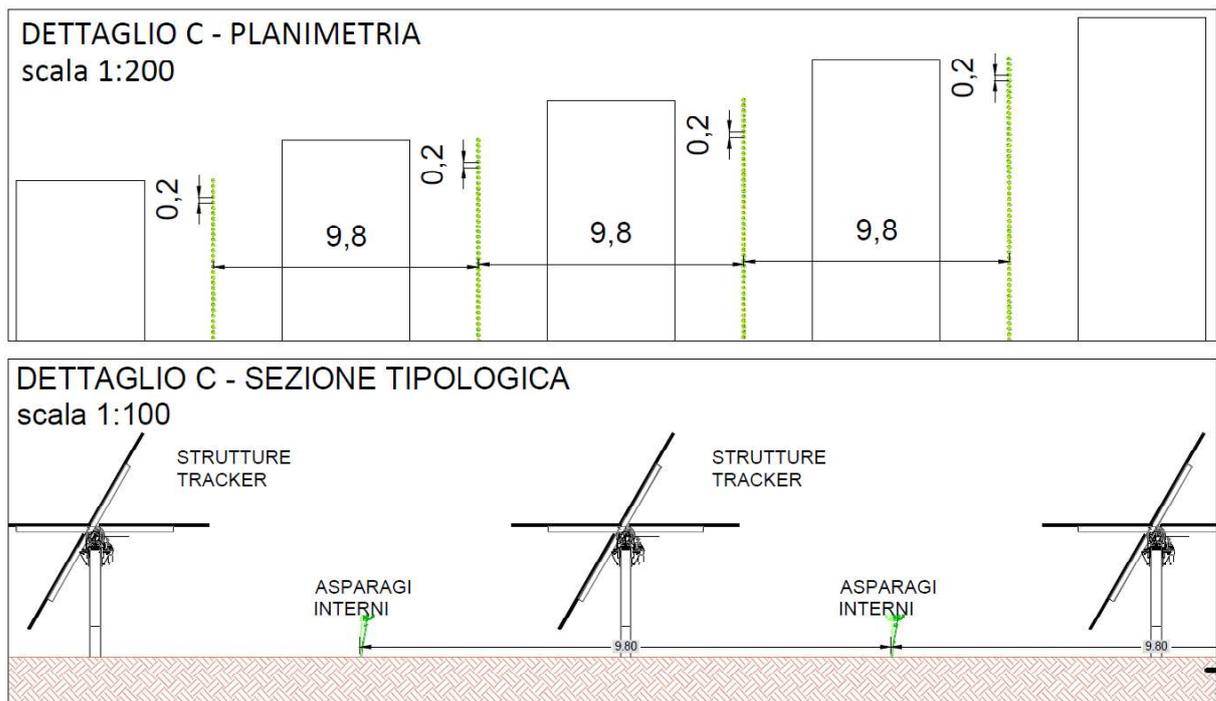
Porzione dell’area oggetto di intervento, sezione tipologica impianto fotovoltaico integrato con asparagiaia
